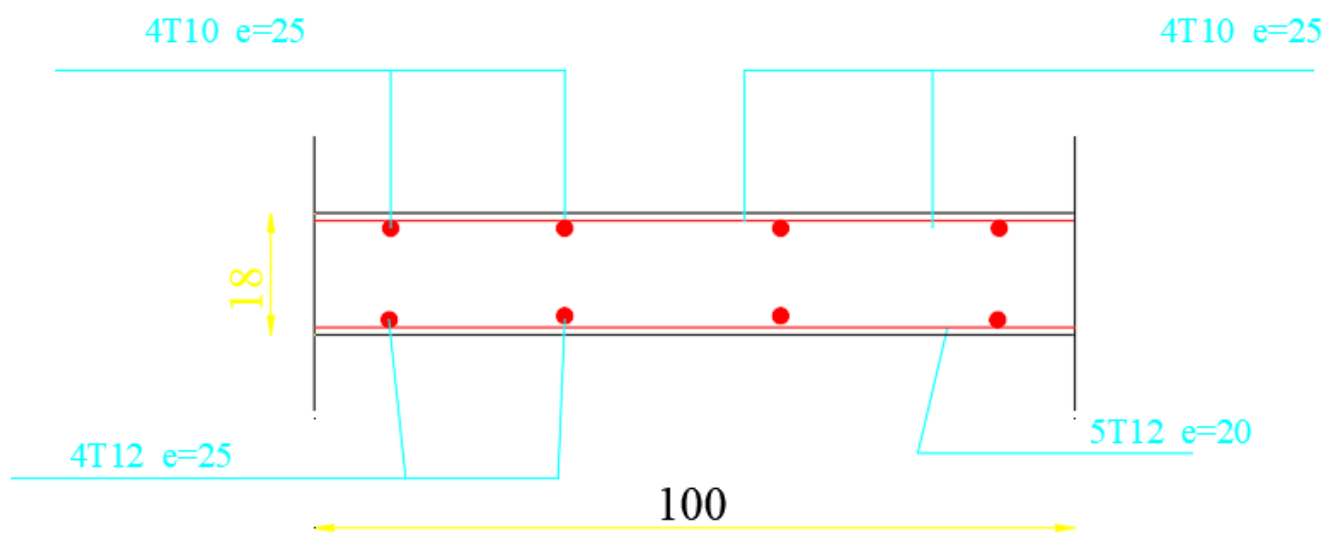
COUPE DE FERRAILLAGE DALLE PLEIN
